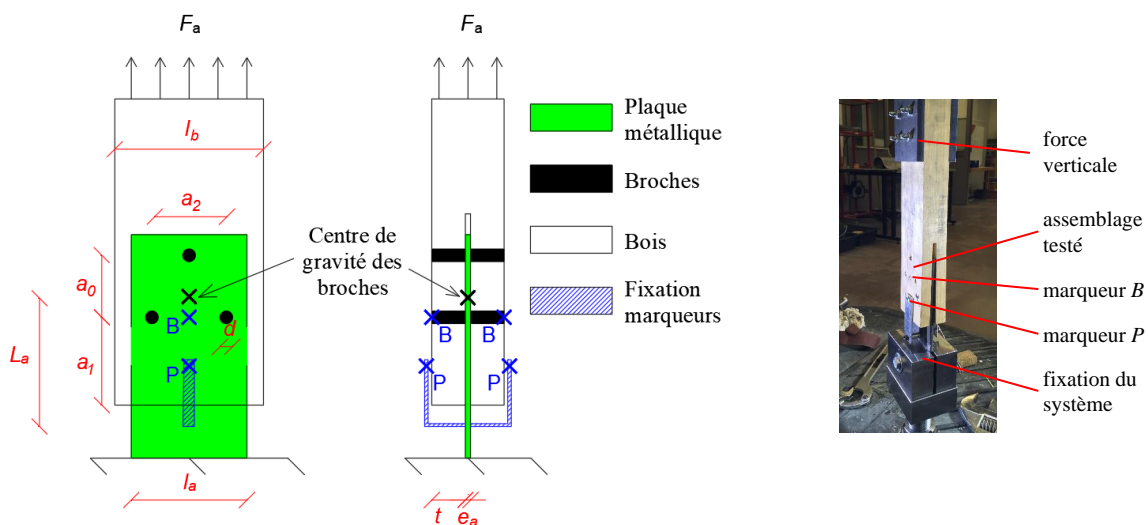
Montage des essais axiaux sur assemblages
